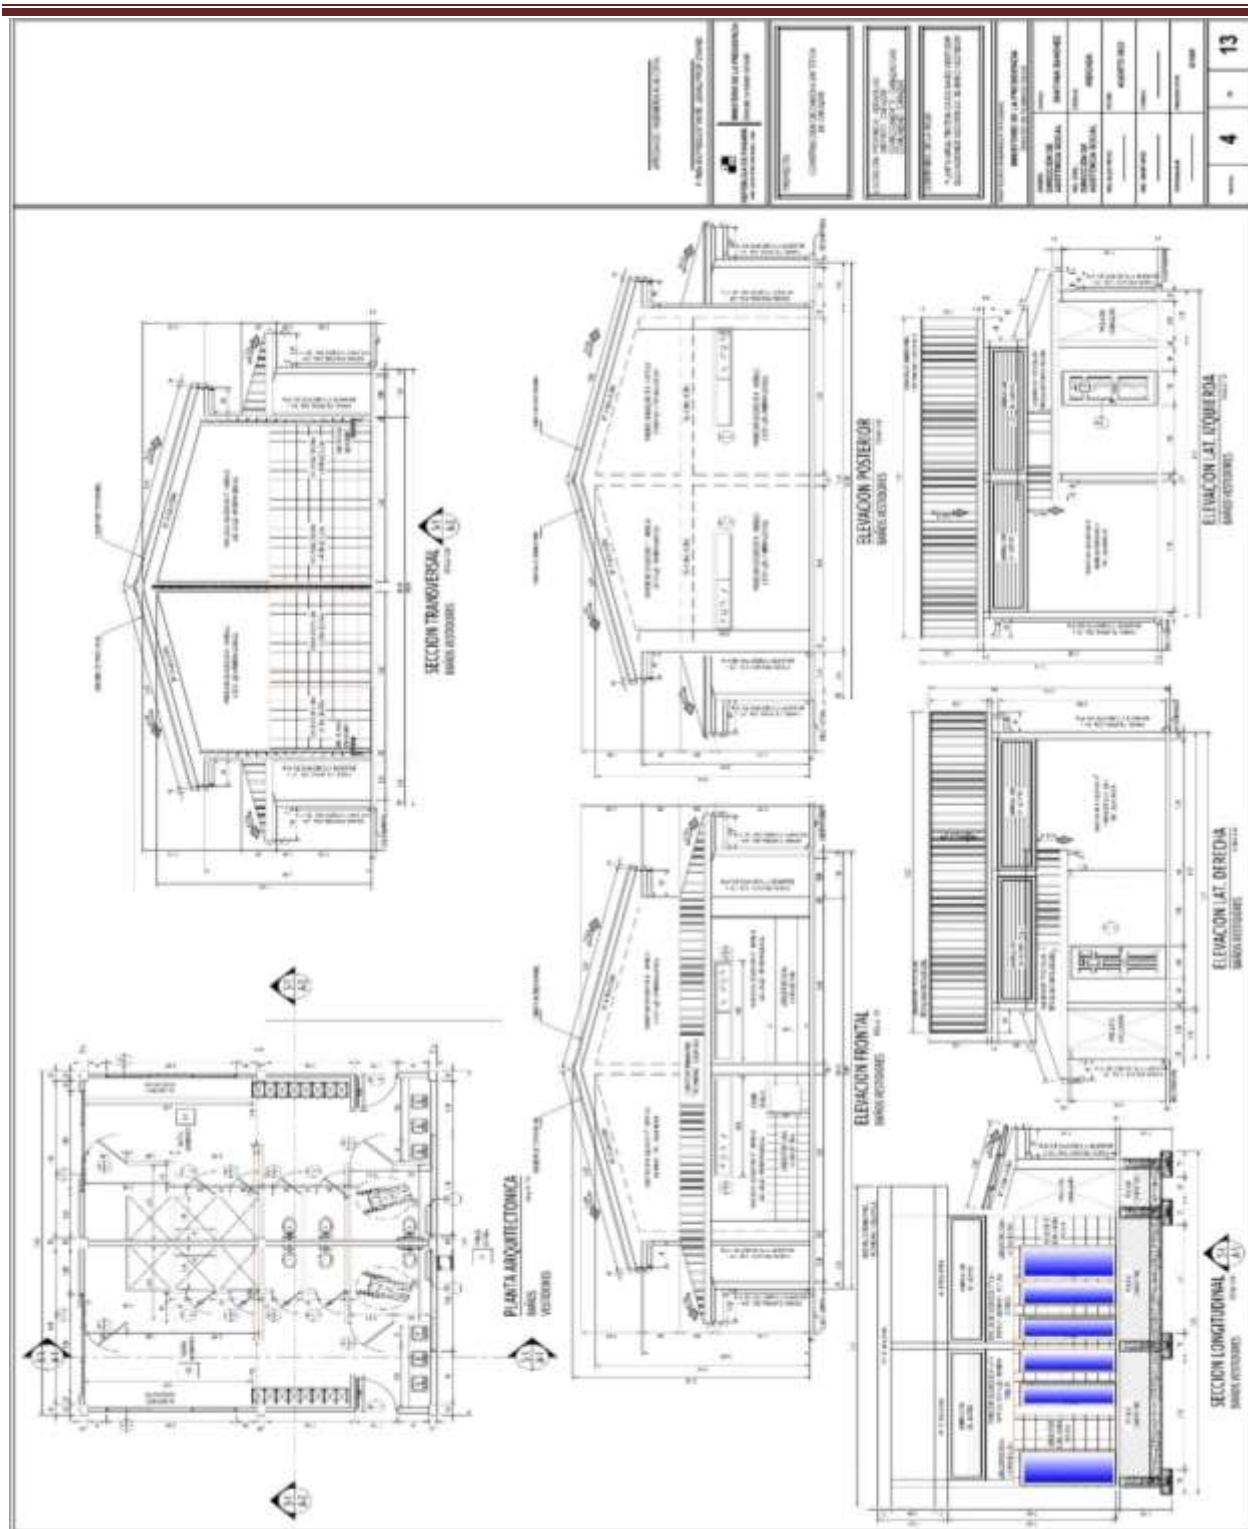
Planta arquitectónica/sección transversal: baños y vestidores (elevaciones lateral, posterior, izquierda, derecha).
